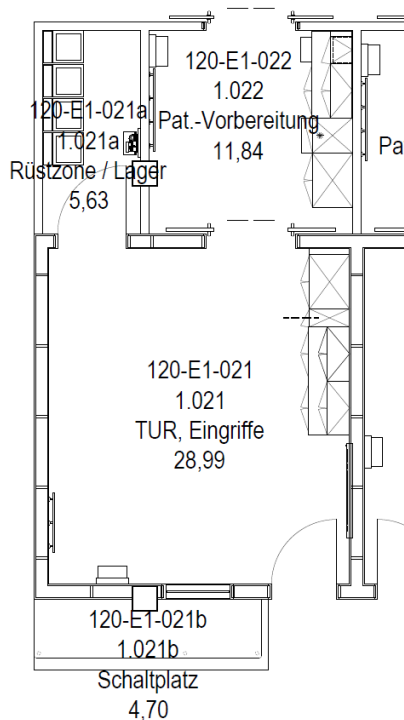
Ausschnitt Grundriss Röntgensystem 1
